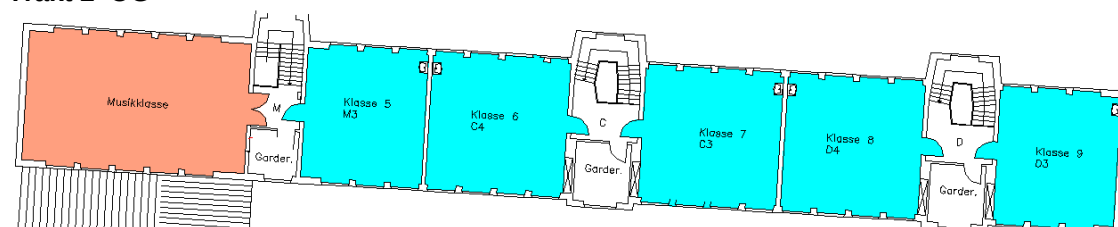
Grundrisszeichnungen, KNX – Ausstattung der Gebäude
